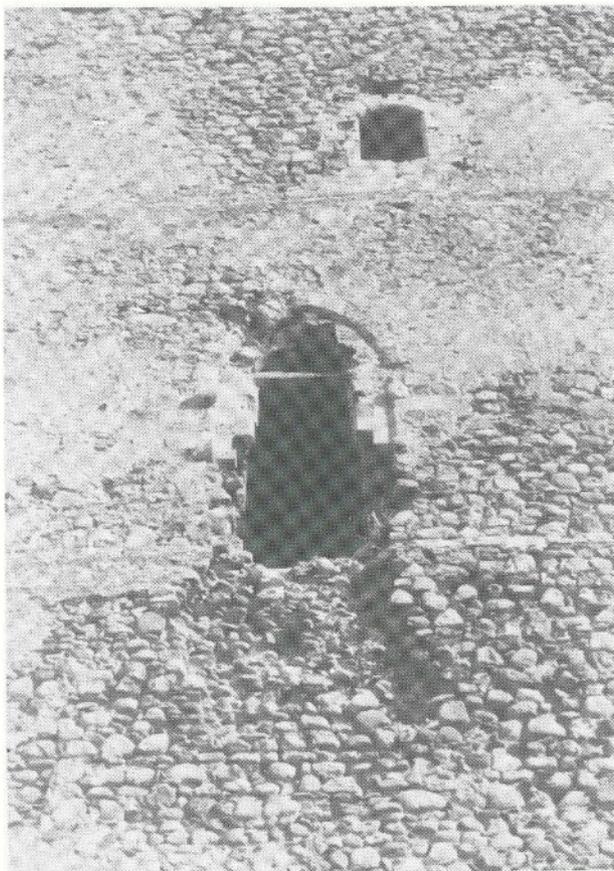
Prospetto O: particolare delle finestre al primo ed al secondo piano.
